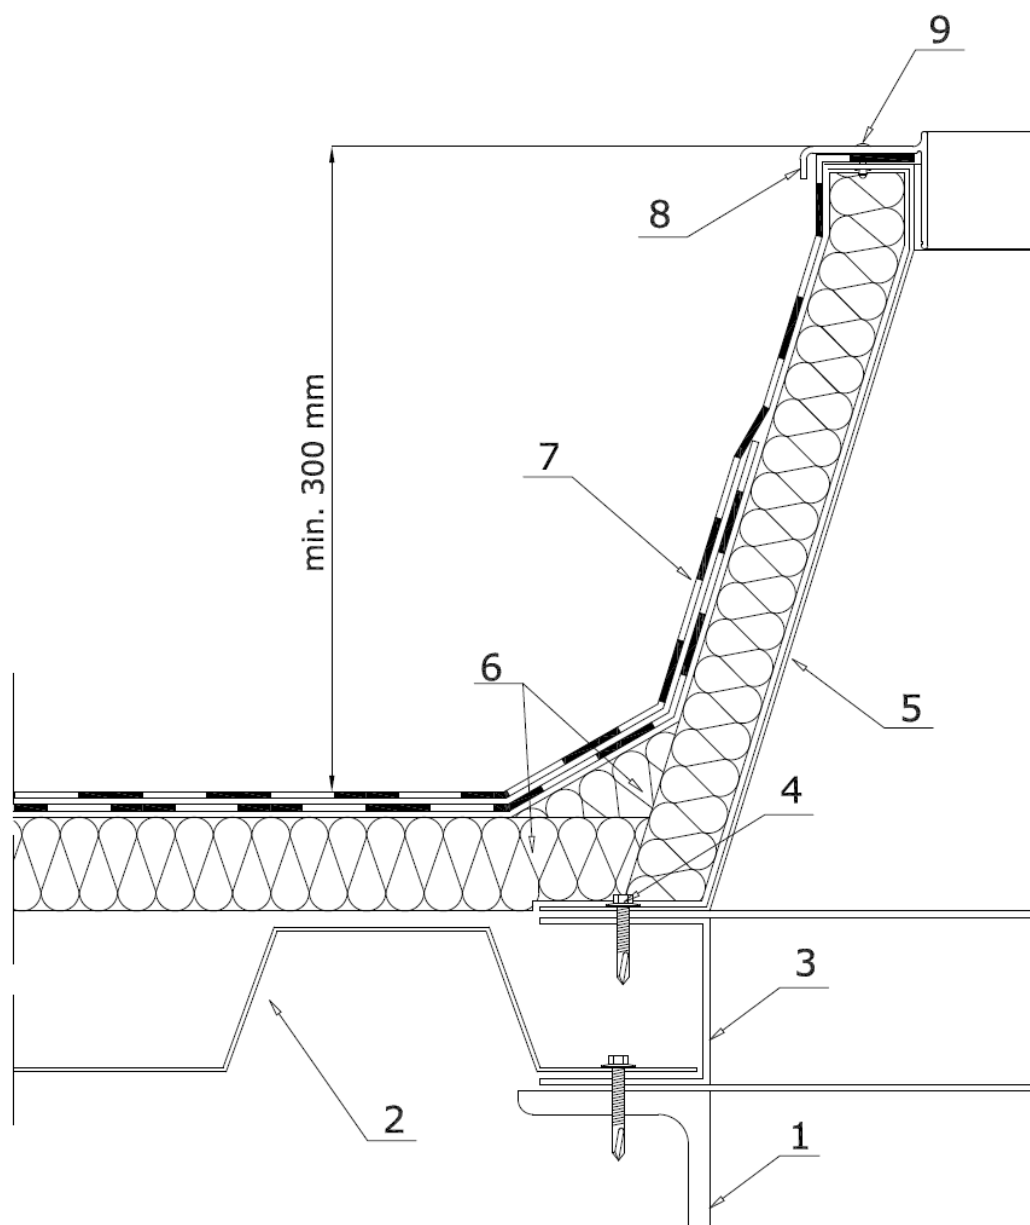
b. Sposób łączenia podstawowych elementów klapy, podstawa z laminatu.
